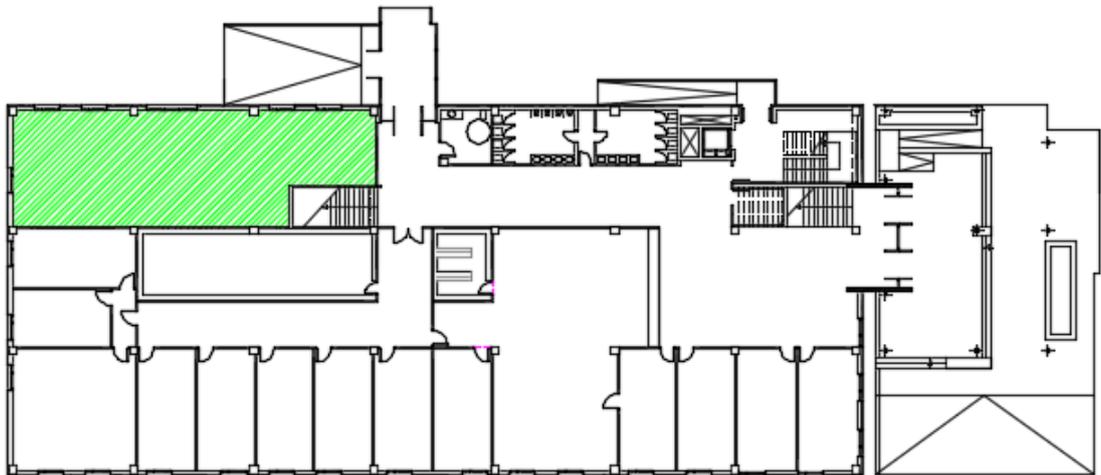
Situación Delegación de Alumnos Planta Baja. Figura extraída del plano 52.
